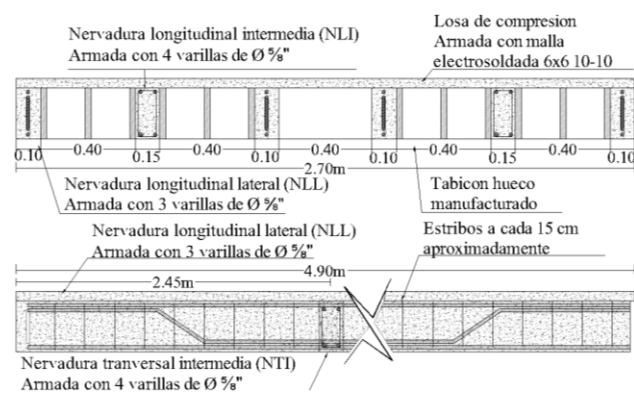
Sección transversal y longitudinal de las nervaduras y su reforzamiento
